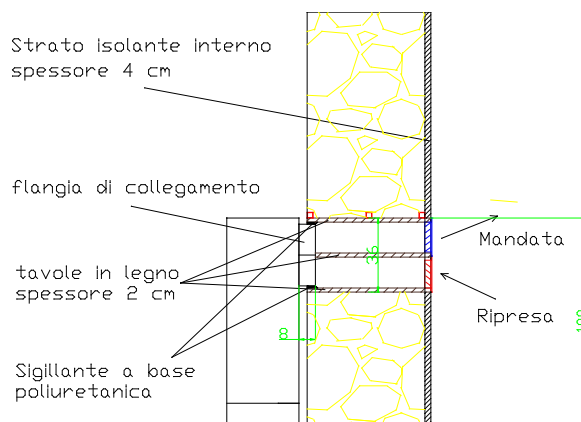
Sezione della parete con il particolare dell'installazione del sistema *freesco façade
